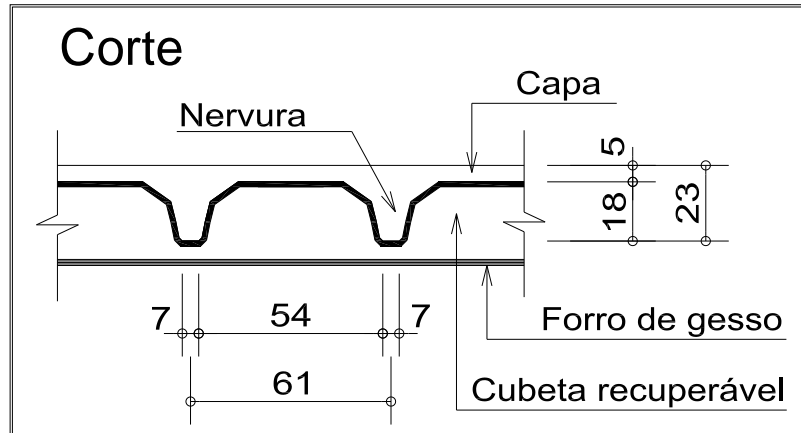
Configuração da laje nervurada com cubeta recuperavel
